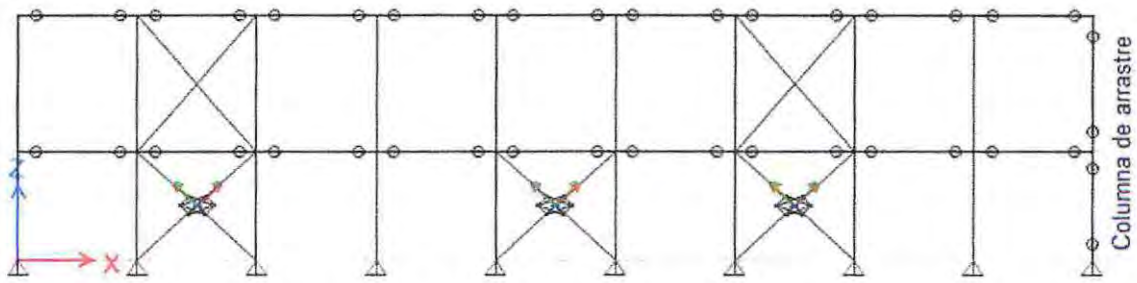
Modelo de análisis plano sistema tradicional con columna de arrastre.
